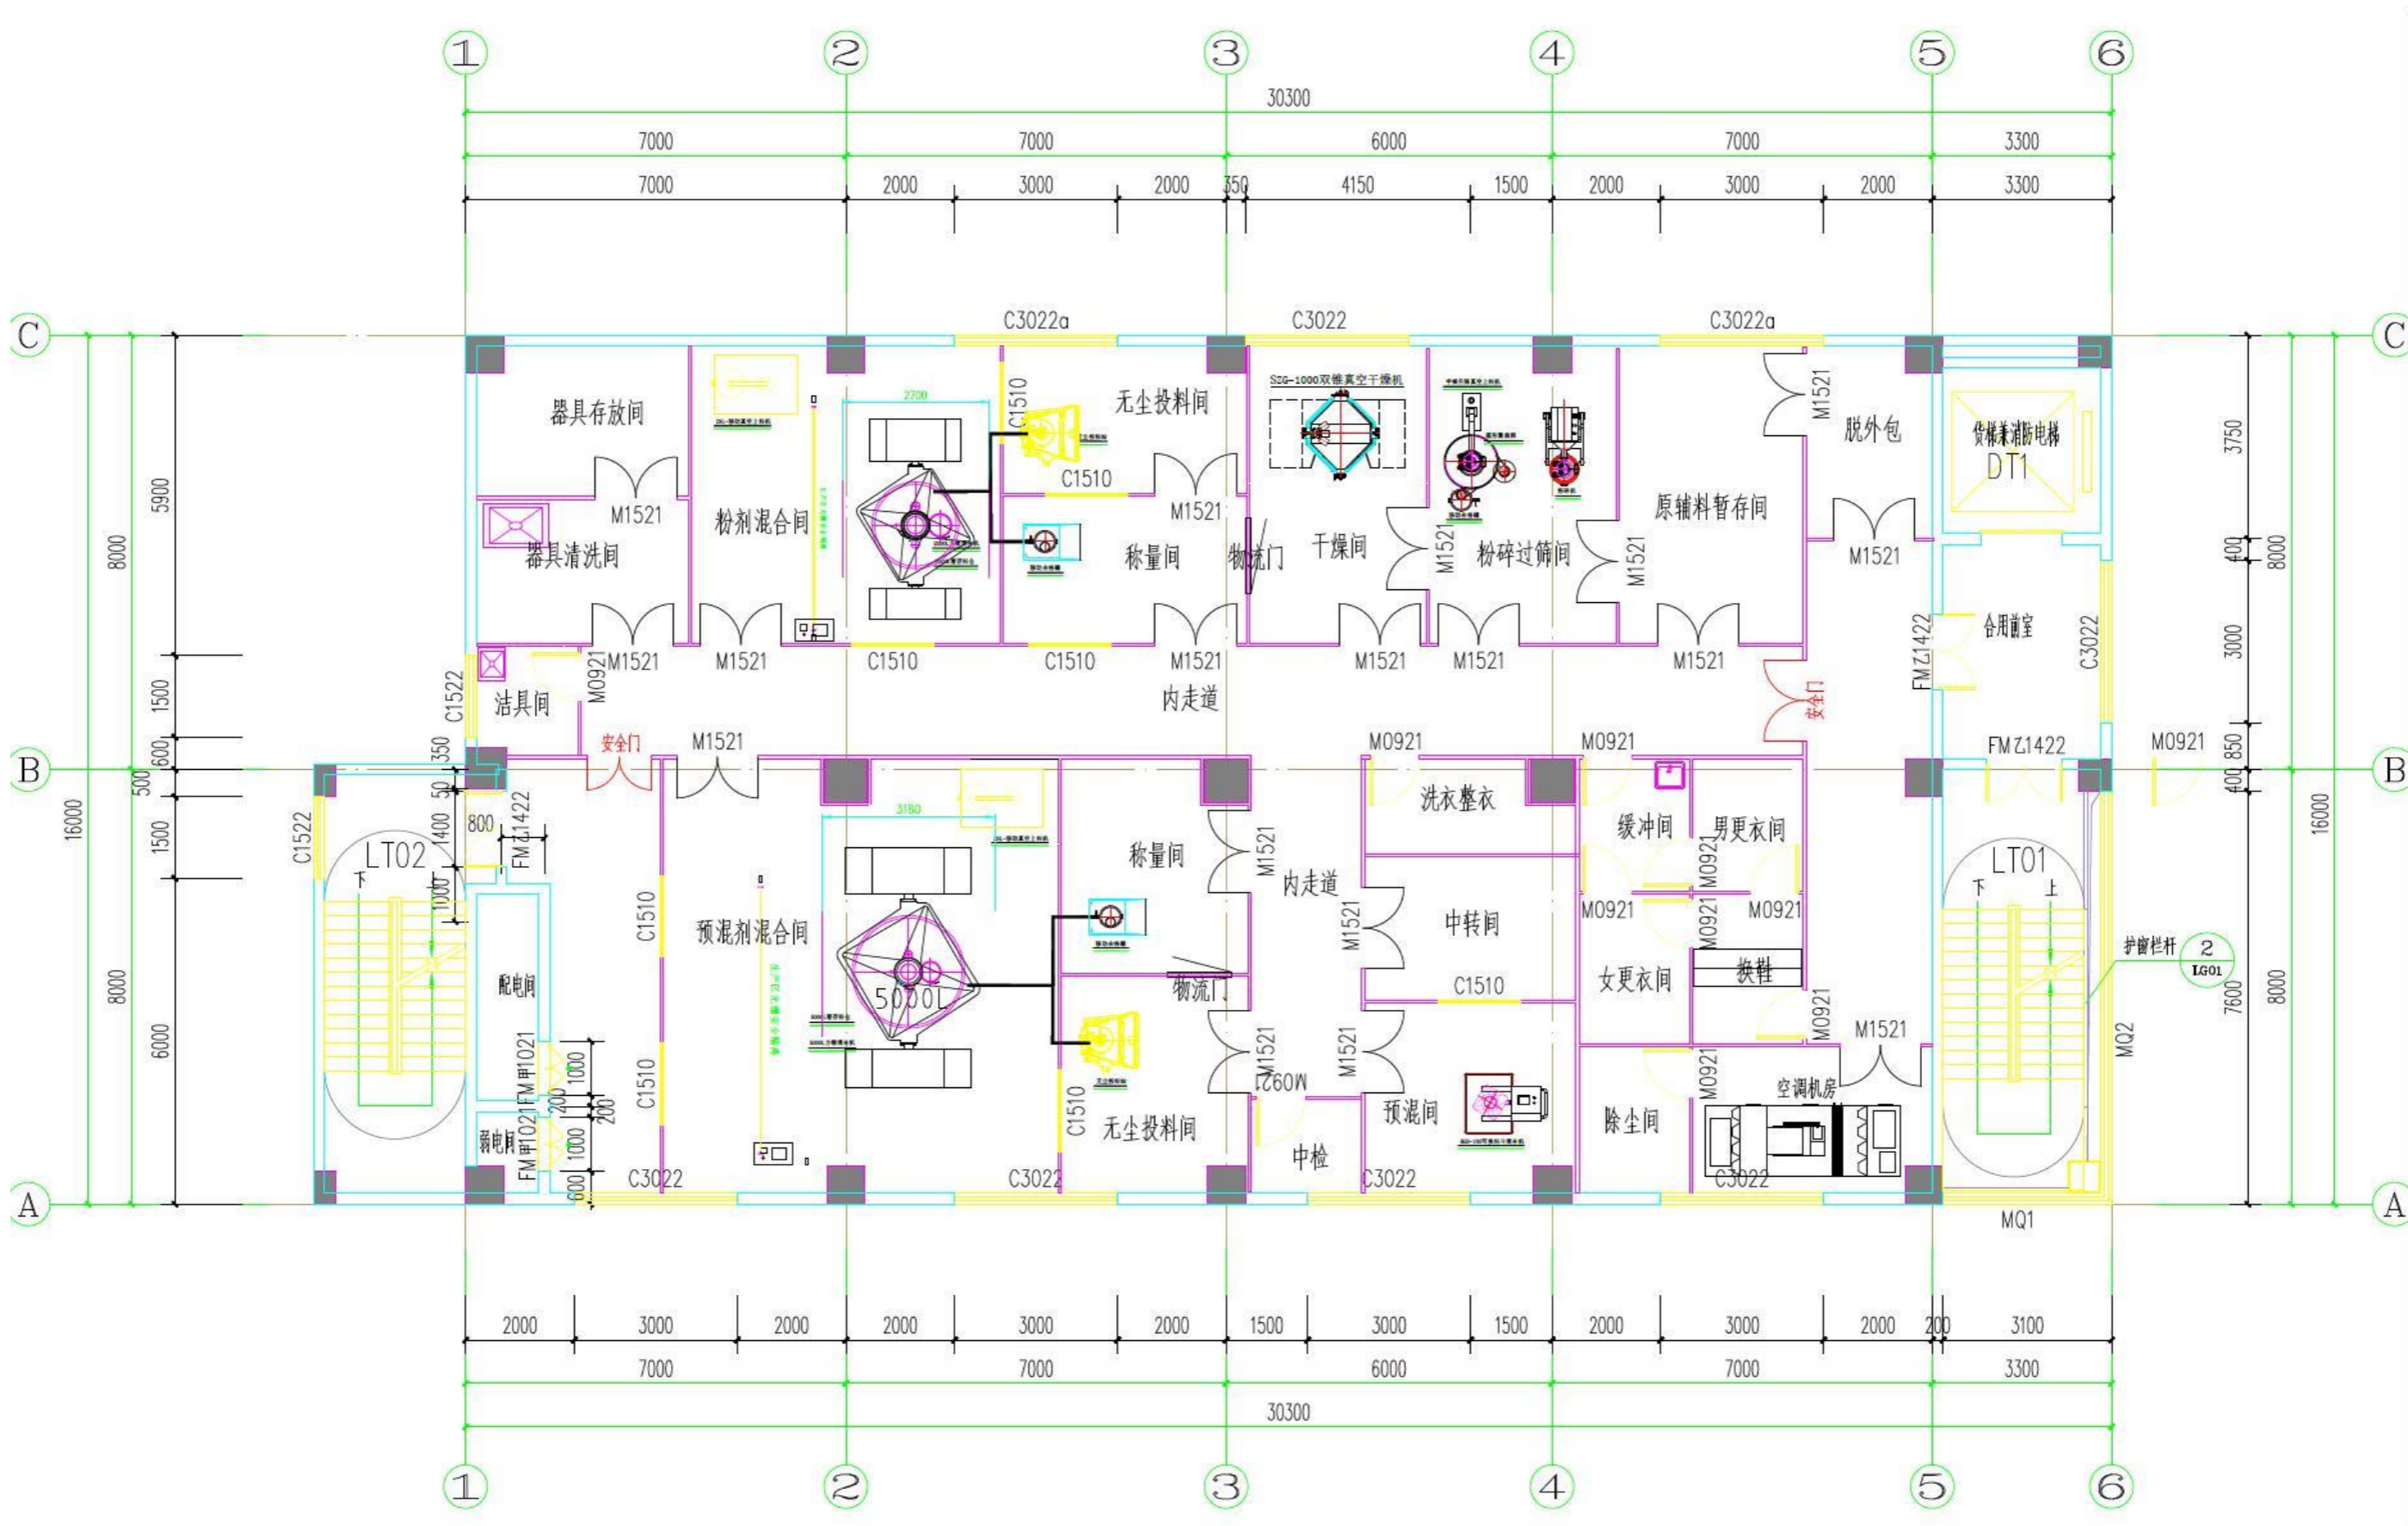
六层（粉剂、预混剂车间）平面布置图（比例尺 1:100）
